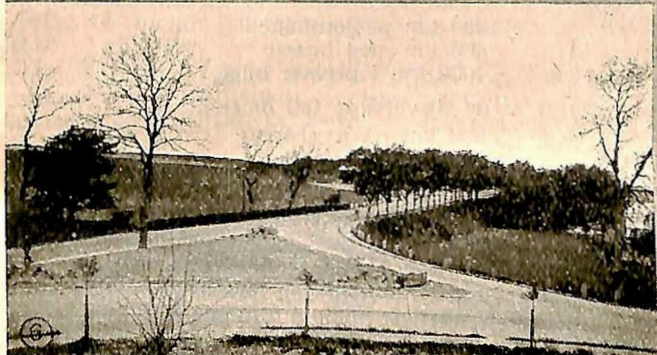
Rommelig dobbeltsporet norsk riksveg, 7,5 m bred, med betongdekke, kjørekant og 1,5 m fortau.
